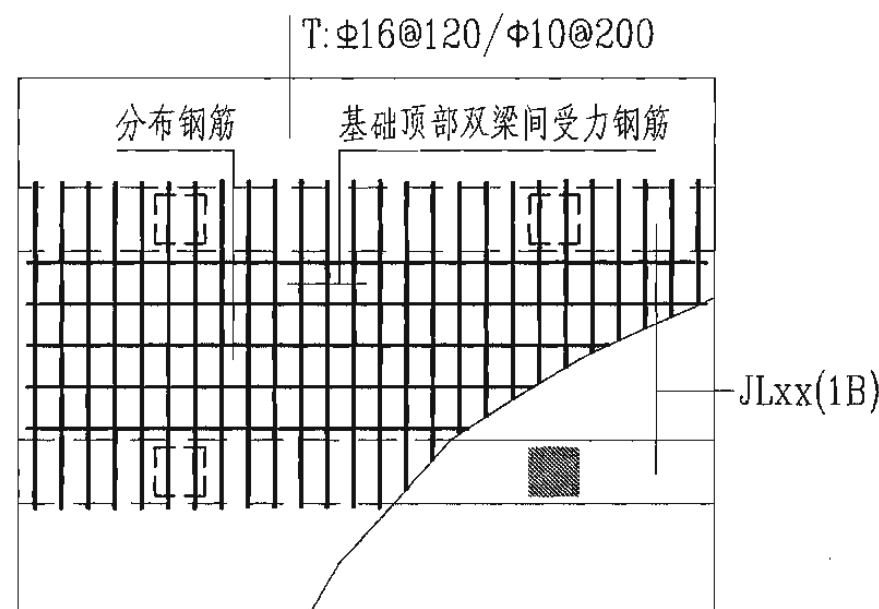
四柱独立基础底板顶部基础梁间配筋注写示意
